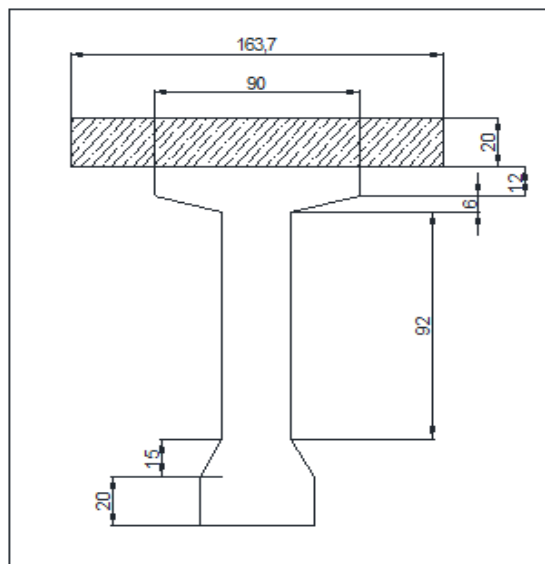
Coupe transversale de la poutre sur appui (prédimensionnement).
